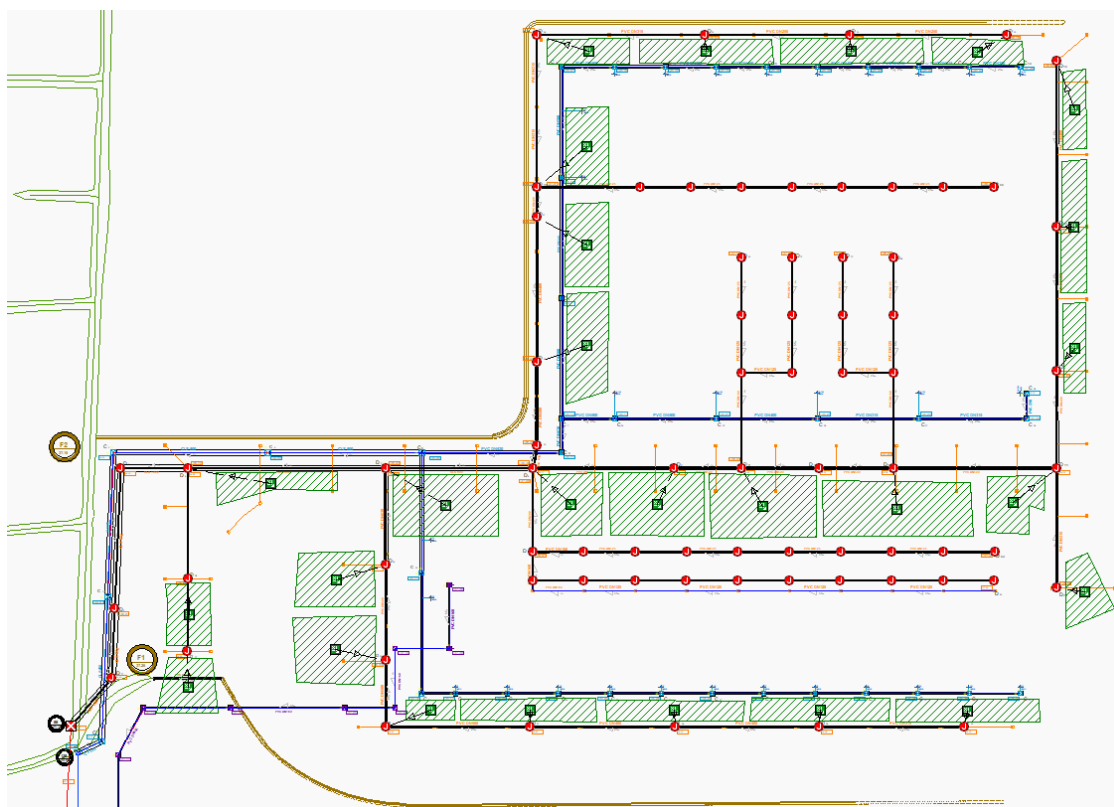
Planimetria del modello della RETE DILAVAMENTO in Autodesk SSA
